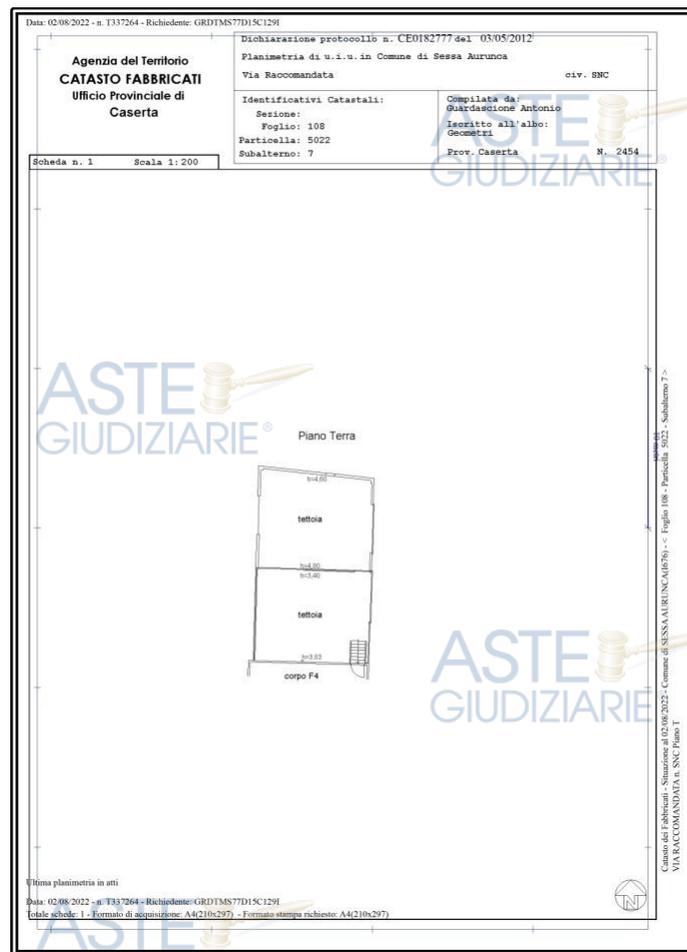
Planimetria catastale sub. 7 (Tettoie)
